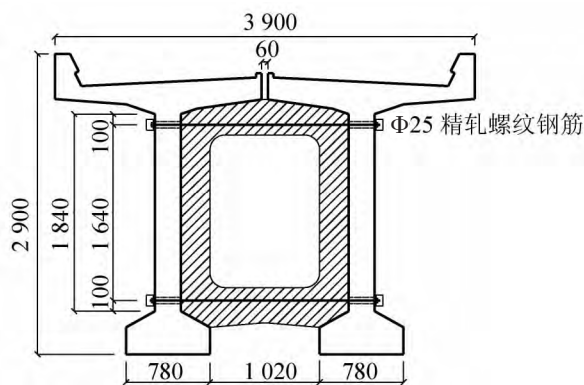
32 m 预应力混凝土并置 T 梁横向加固示意图(单位:mm)
